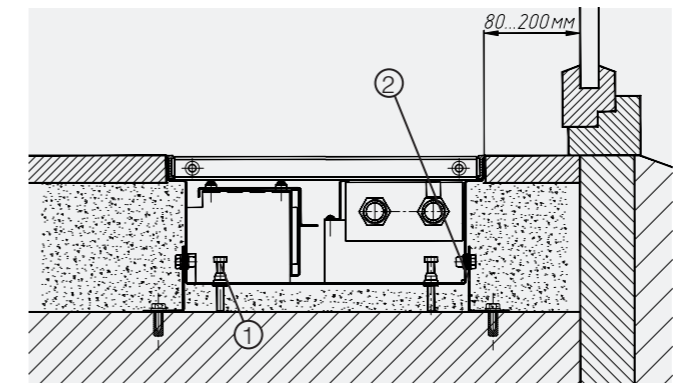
Монтаж внутрипольного конвектора: 1 – упорные болты; 2 – опоры для крепления к полу
